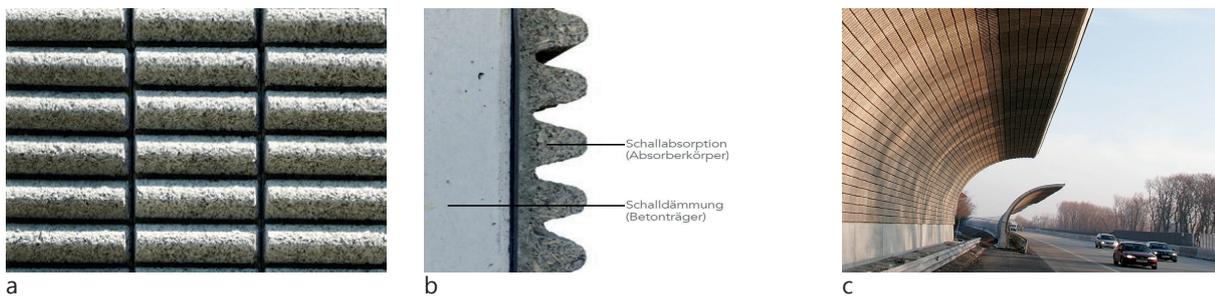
Lärmschutzwände aus Holzwollebeton; a Offenporige Oberfläche; b Holzwolle auf Trägerbeton; c Schallschutzanlage in gebogener Ausführung
